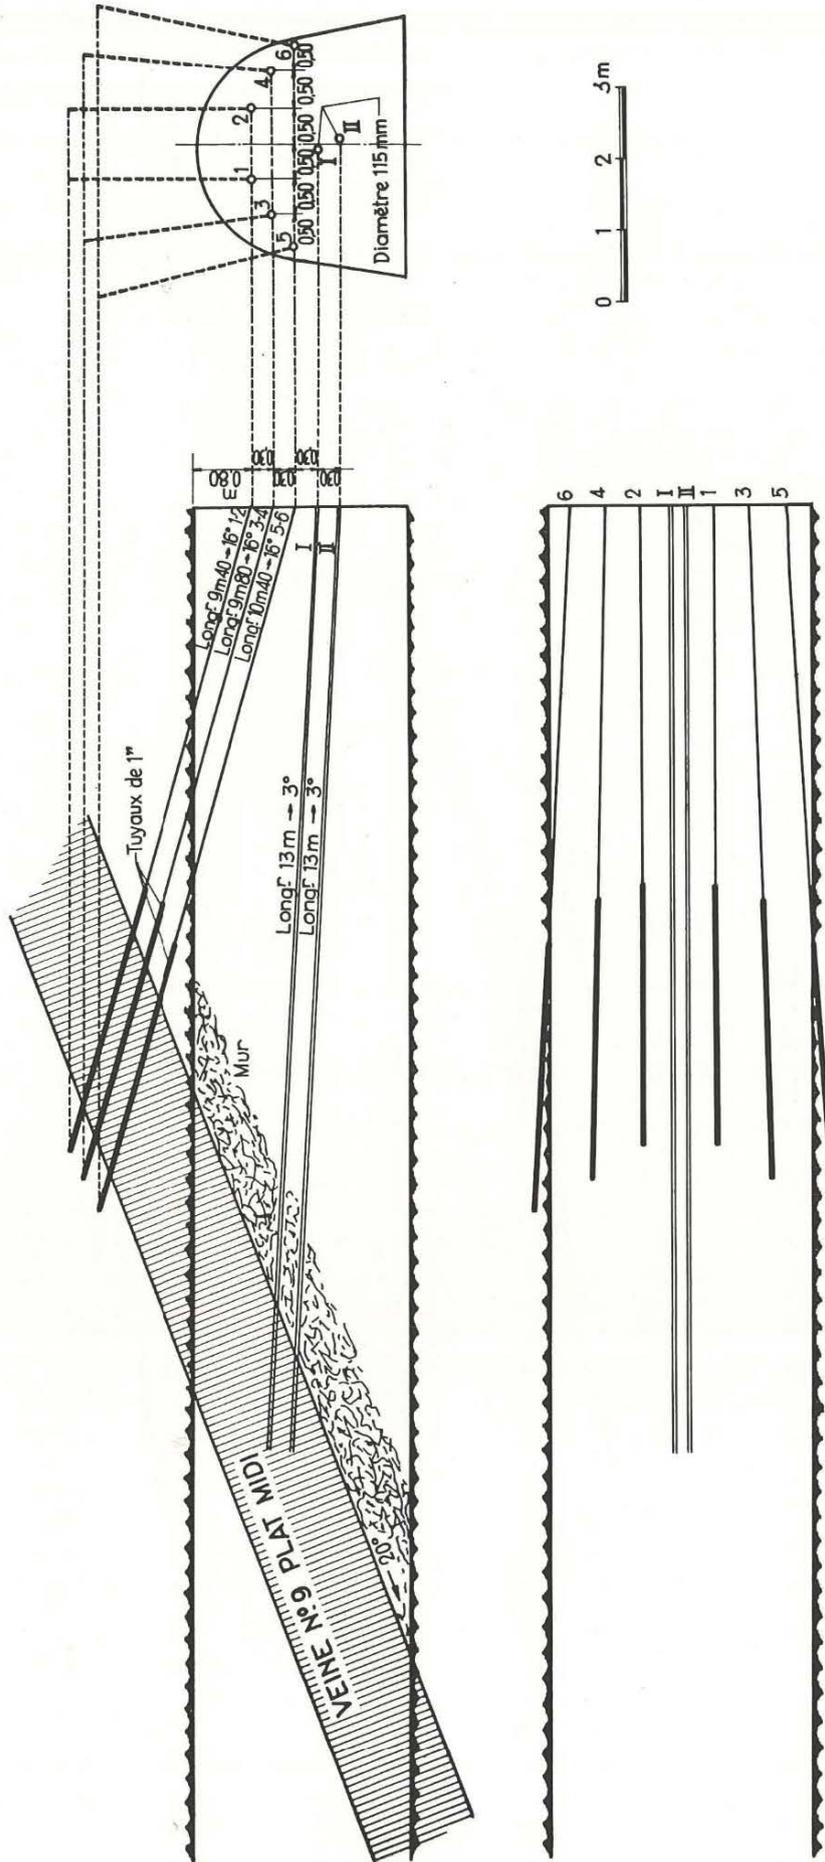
Projet d'affouillement hydraulique d'une couche.
